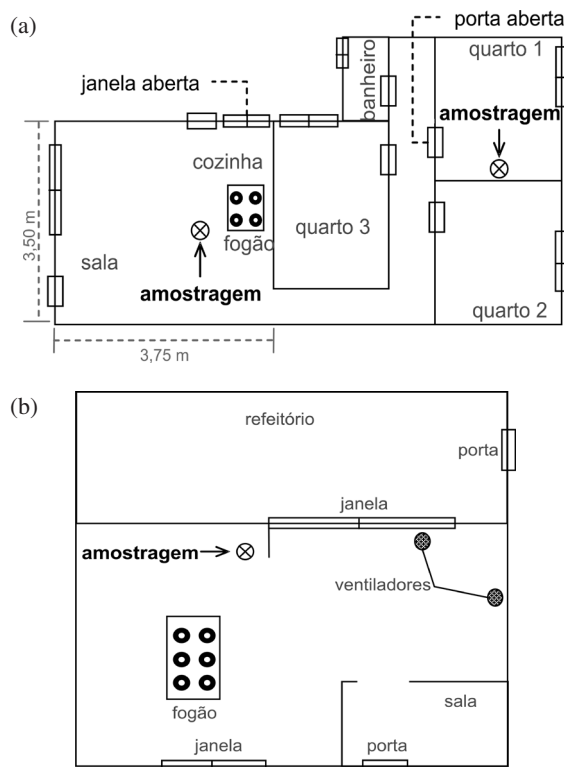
(a) Planta baixa do local de amostragem residencial, (b) planta baixa da cozinha do restaurante universitário do campus da UNESP de Araraquara
